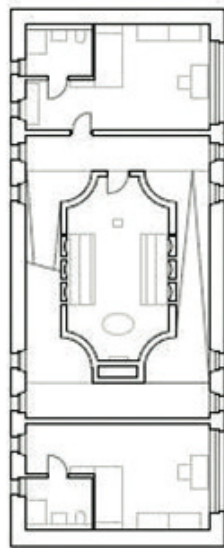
Planul capelei de la parter/ Ground floor plan, the chapel.
